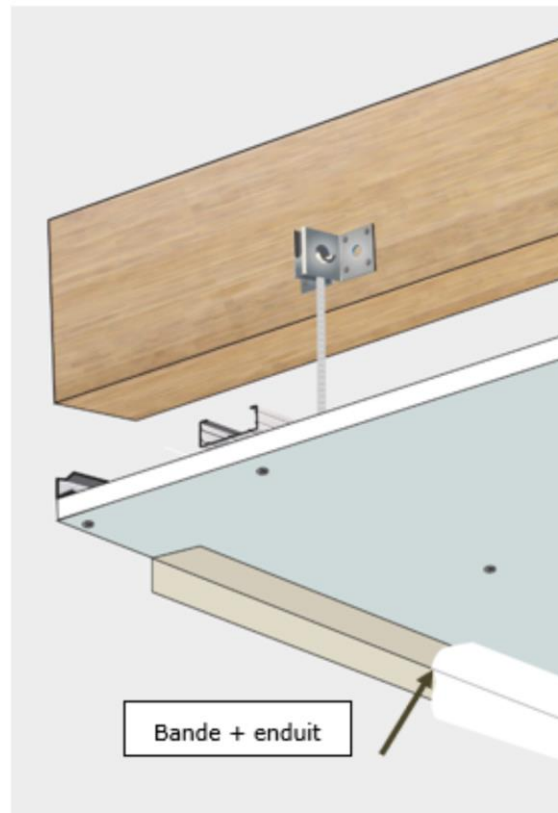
Dispositif de suspension sous charpente bois-Détail raccordement plafond – mur avec bande + enduit
